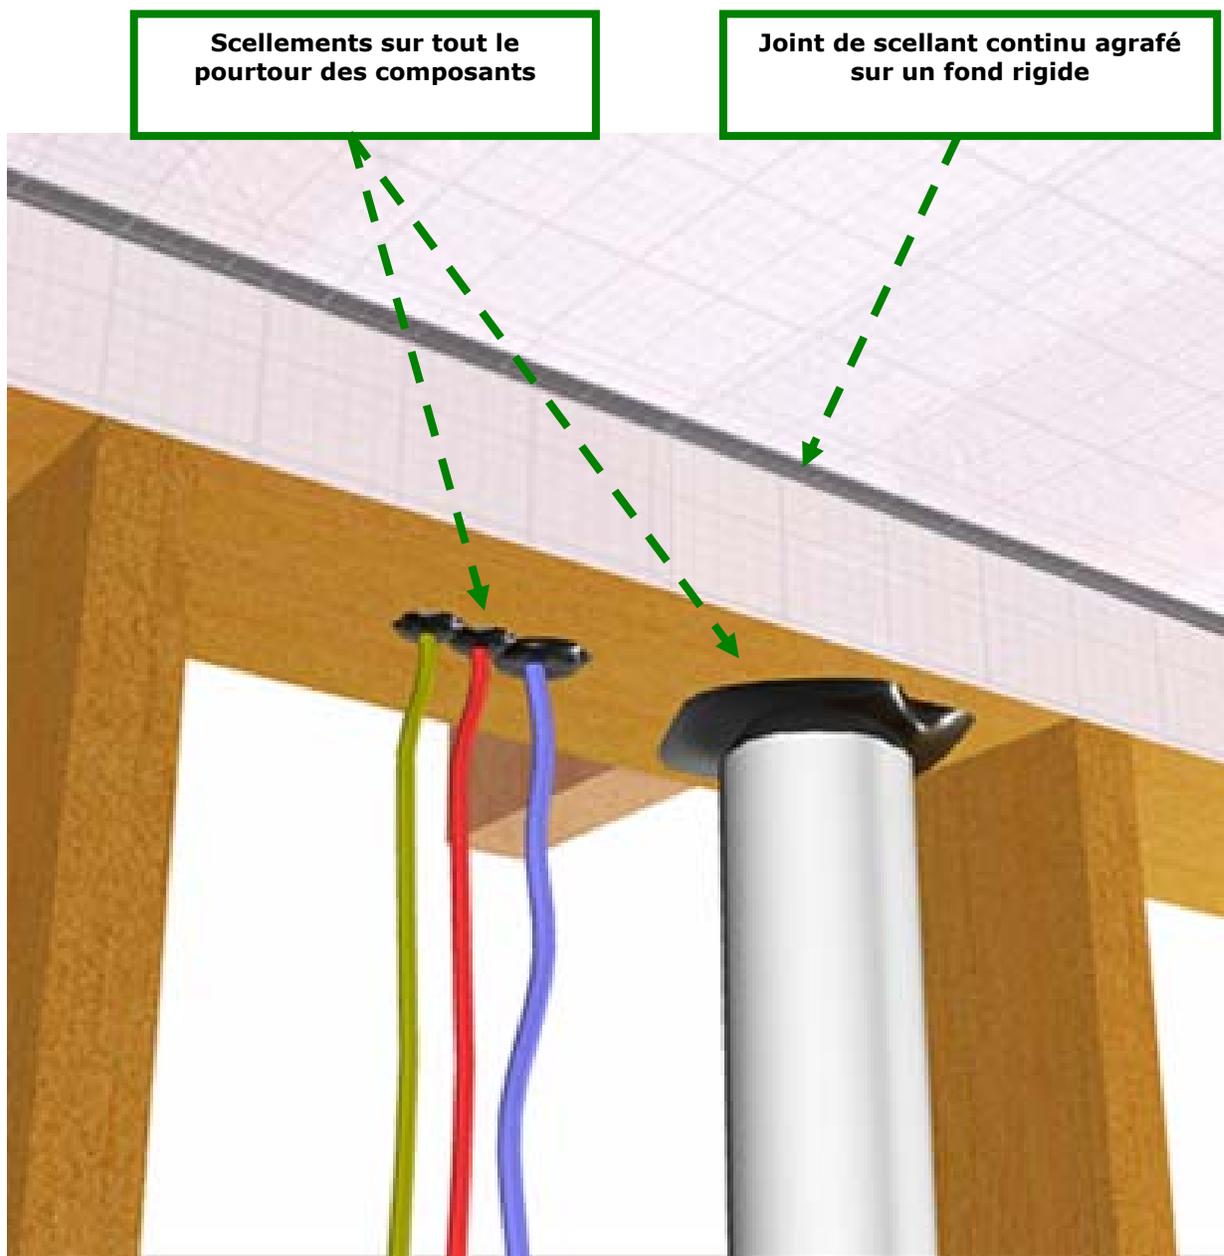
Étanchéité des conduits, tuyaux et canalisation traversant l'enveloppe (art.2.2.2.10)
